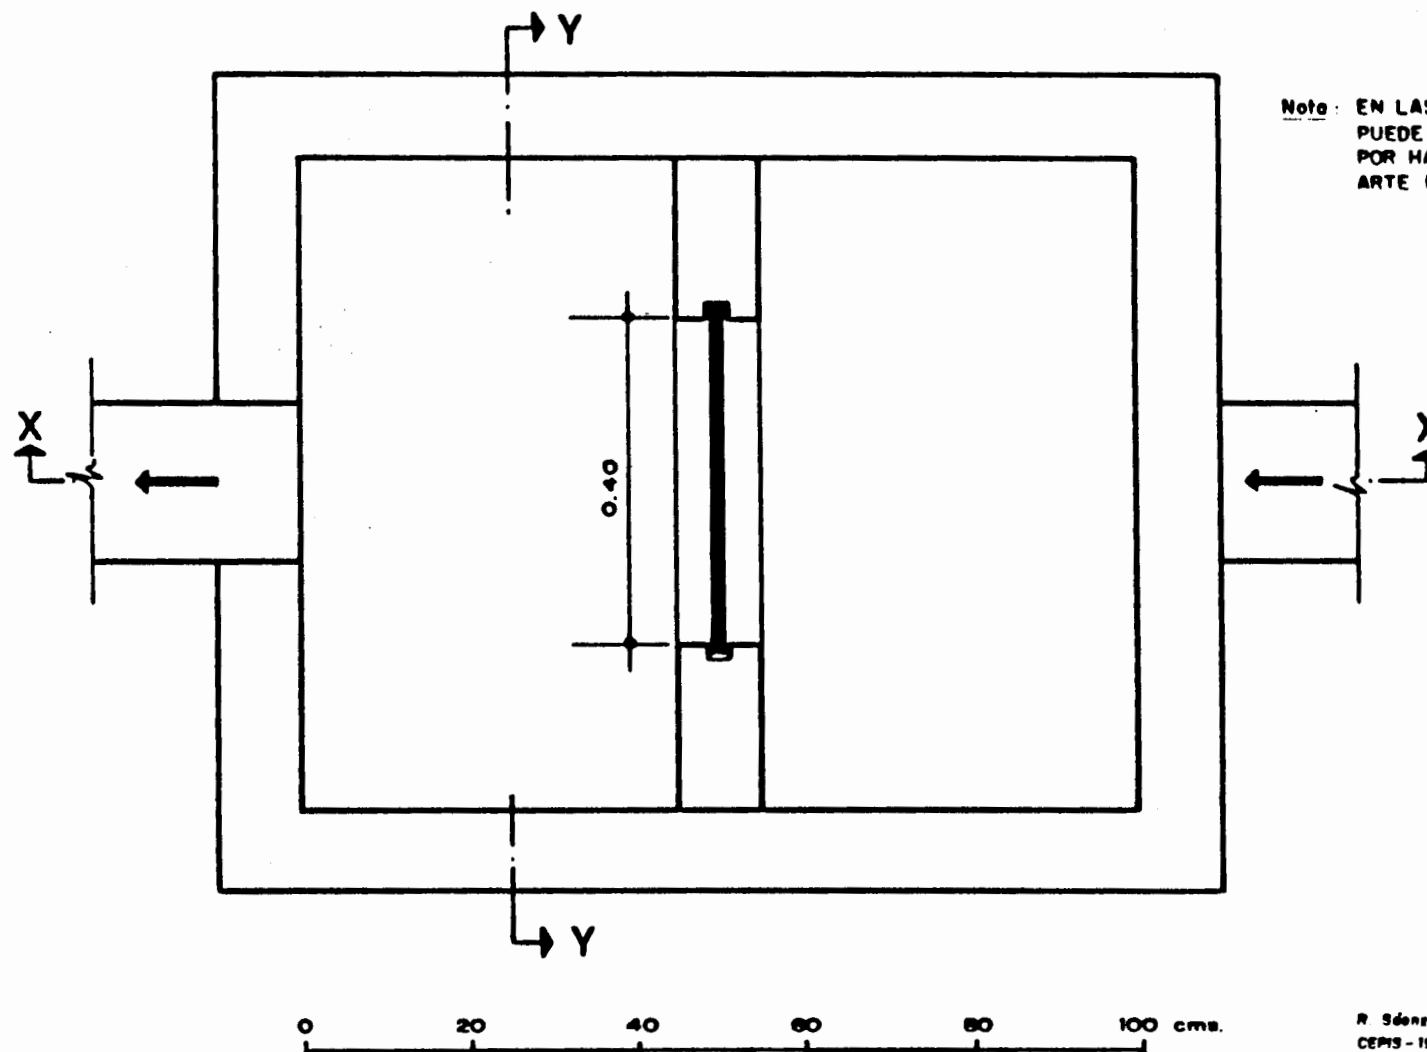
VISTA DE PLANTA DE LA CAJA DE LAS ESTRUCTURAS DE ENTRADA. OBRAS DE ARTE Nos. 2 Y 6
